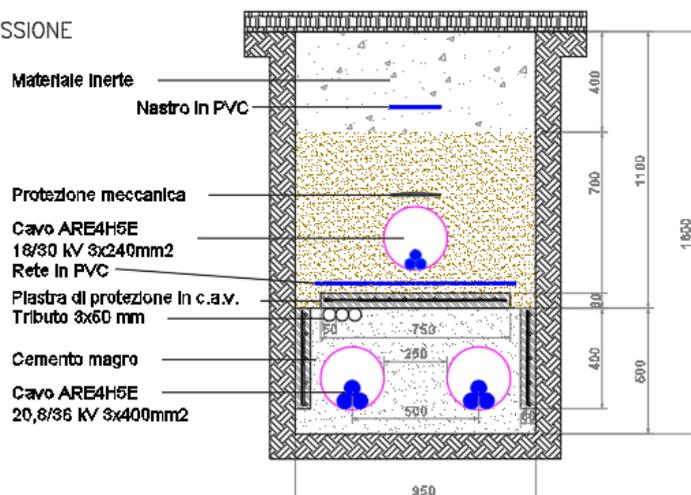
Sezione tipo MT in condivisione con linea AT su terreno agricolo
